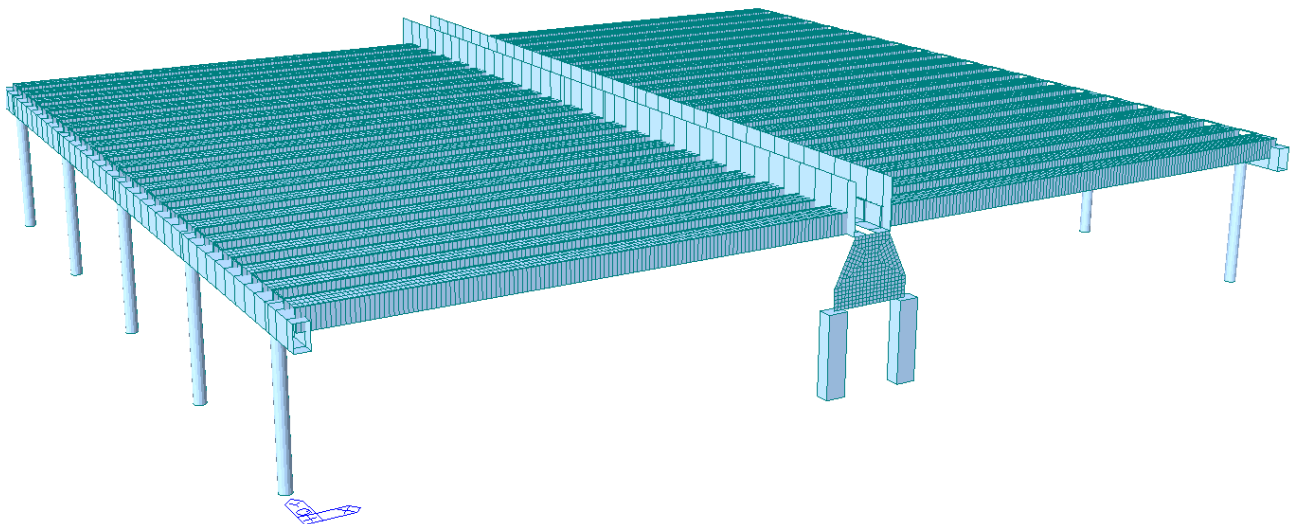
Vista 3D del modello globale del fabbricato. Vista prospettica.
